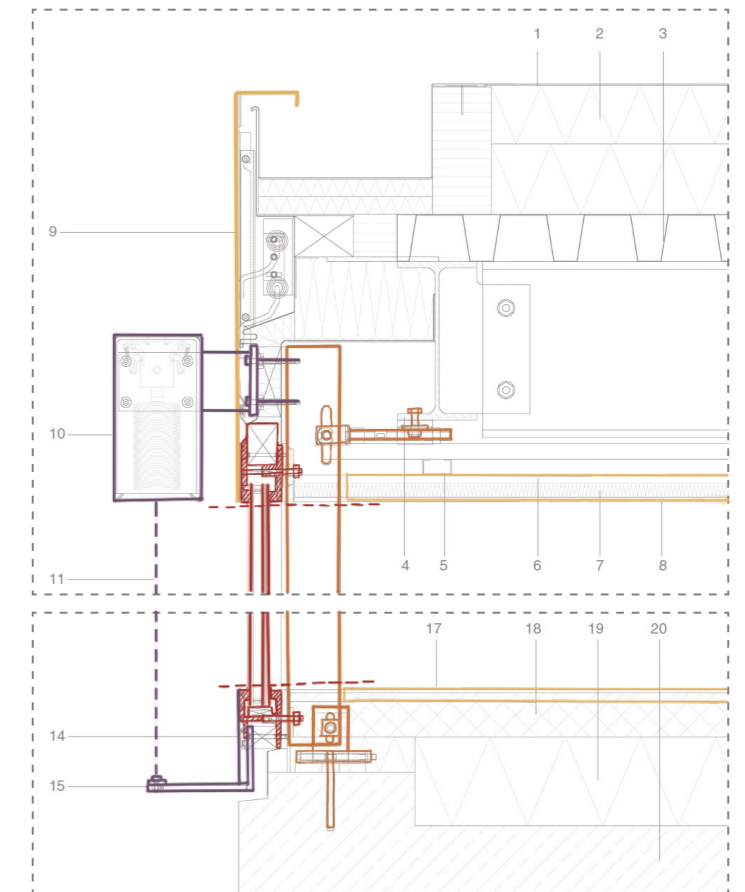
Detalle constructivo del sistema de cerramiento anclado a la estructura
